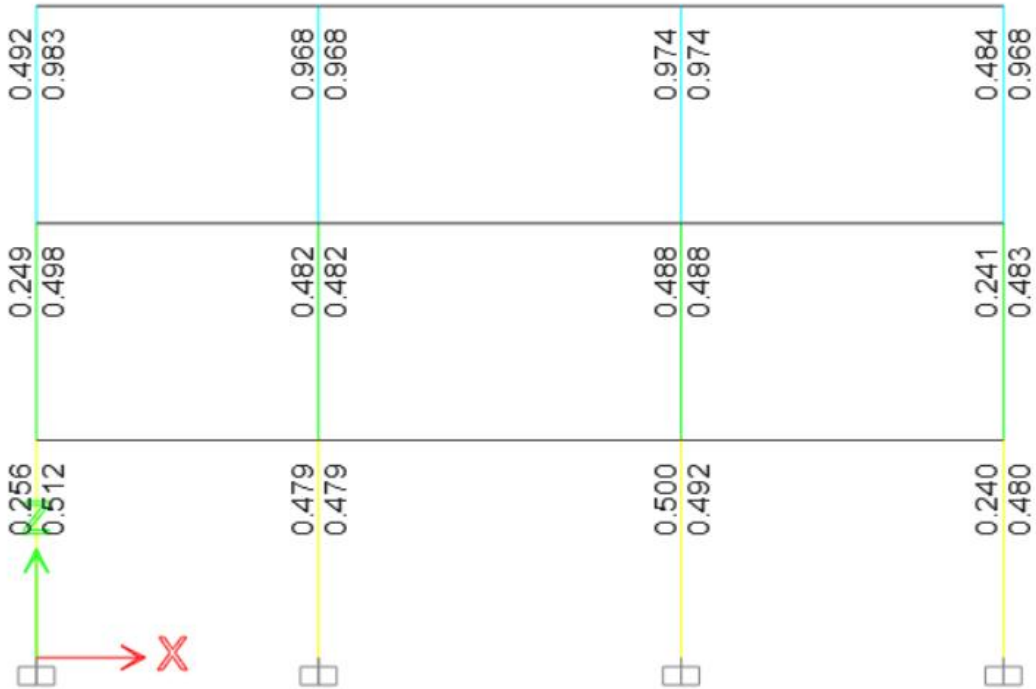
Chequeo conexión viga- columna. Columna fuerte- Viga débil
